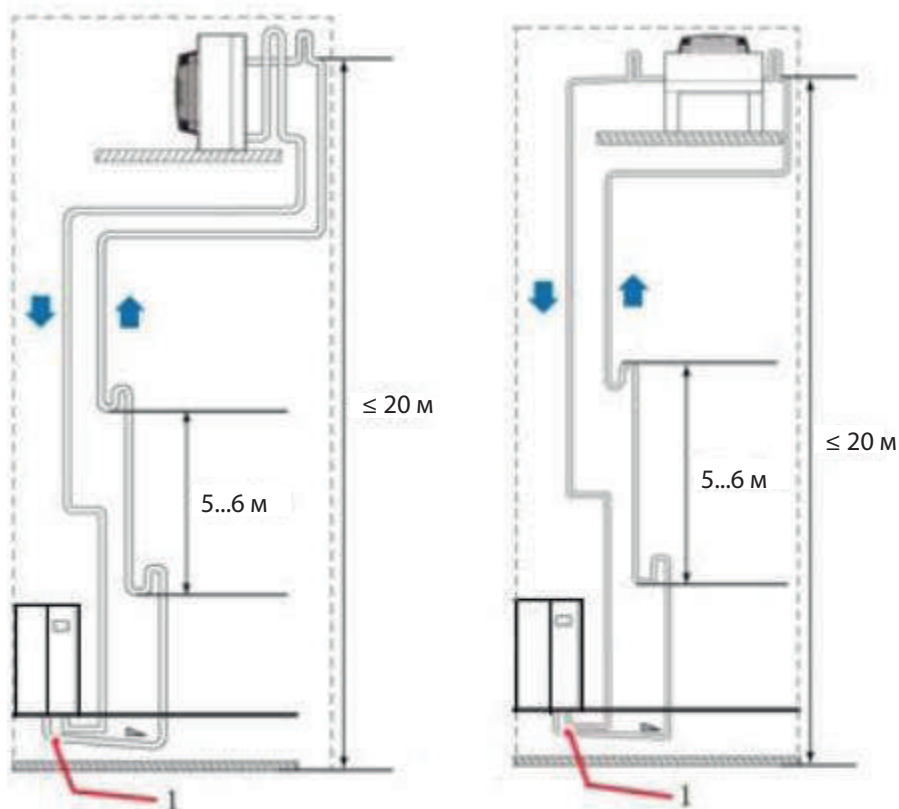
«Схема компоновки с конденсатором выше компрессора».
